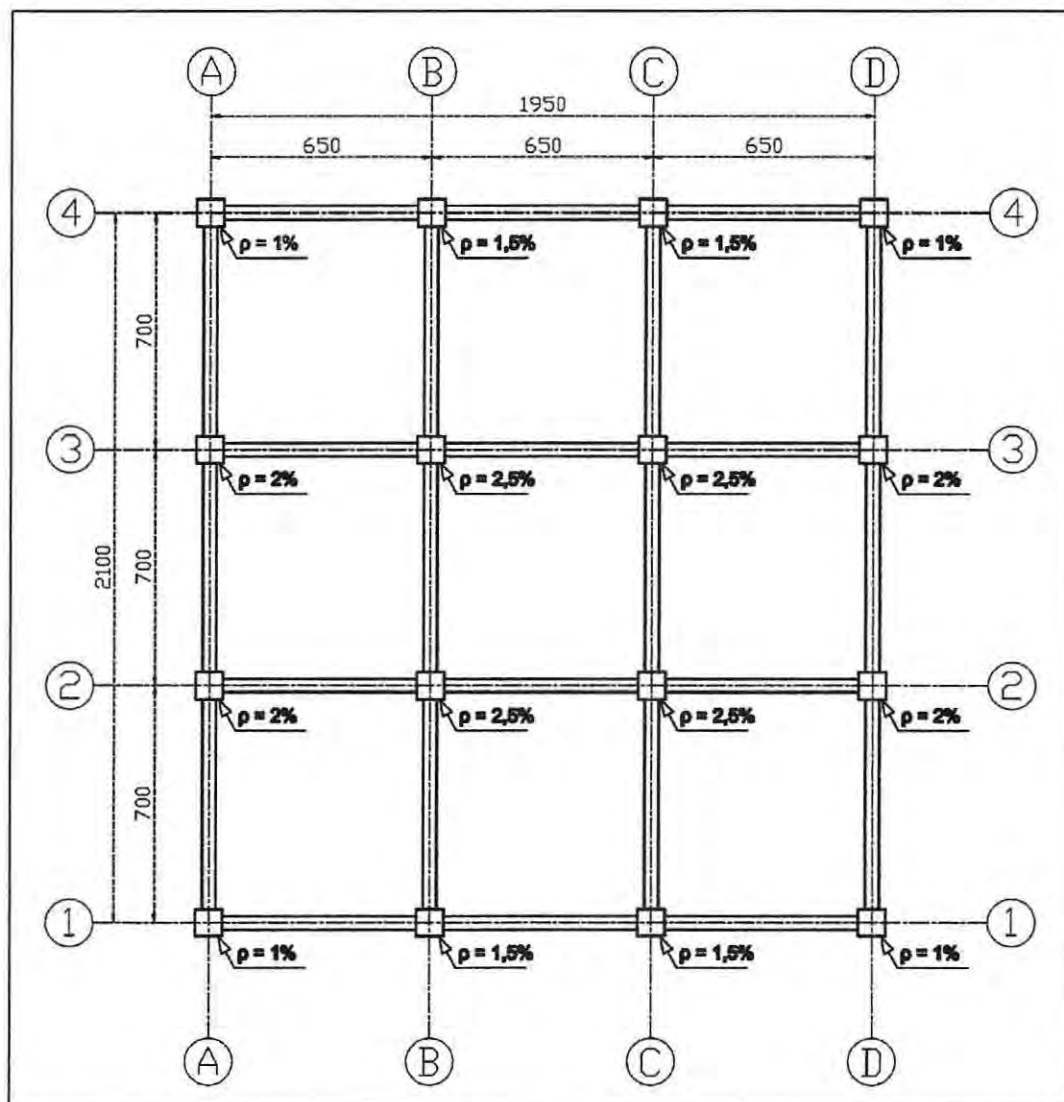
Planta de distribución de columnas en sistema de marcos.
